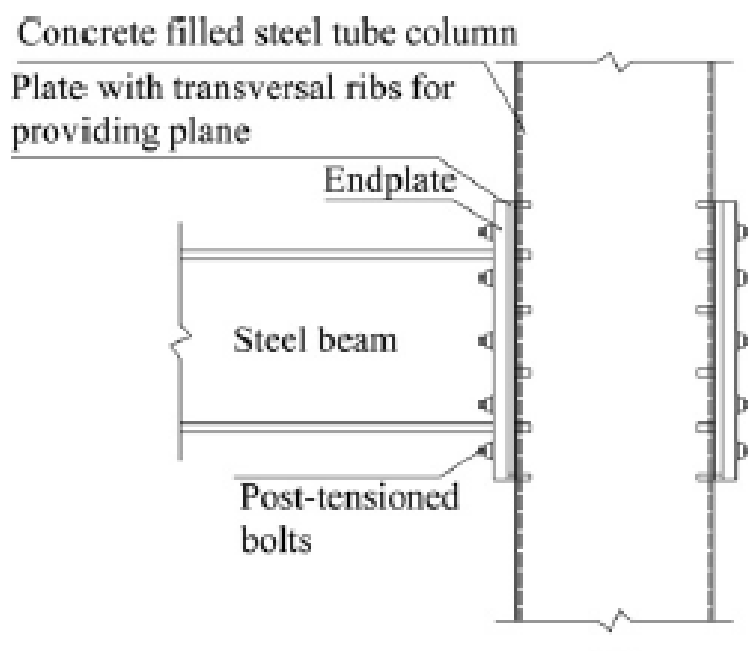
Conexión entre columna tubular rellena de concreto y viga en I, similar a la estudiada en este trabajo. Fuente: (Li, Wu, & Xiao, 2009).
